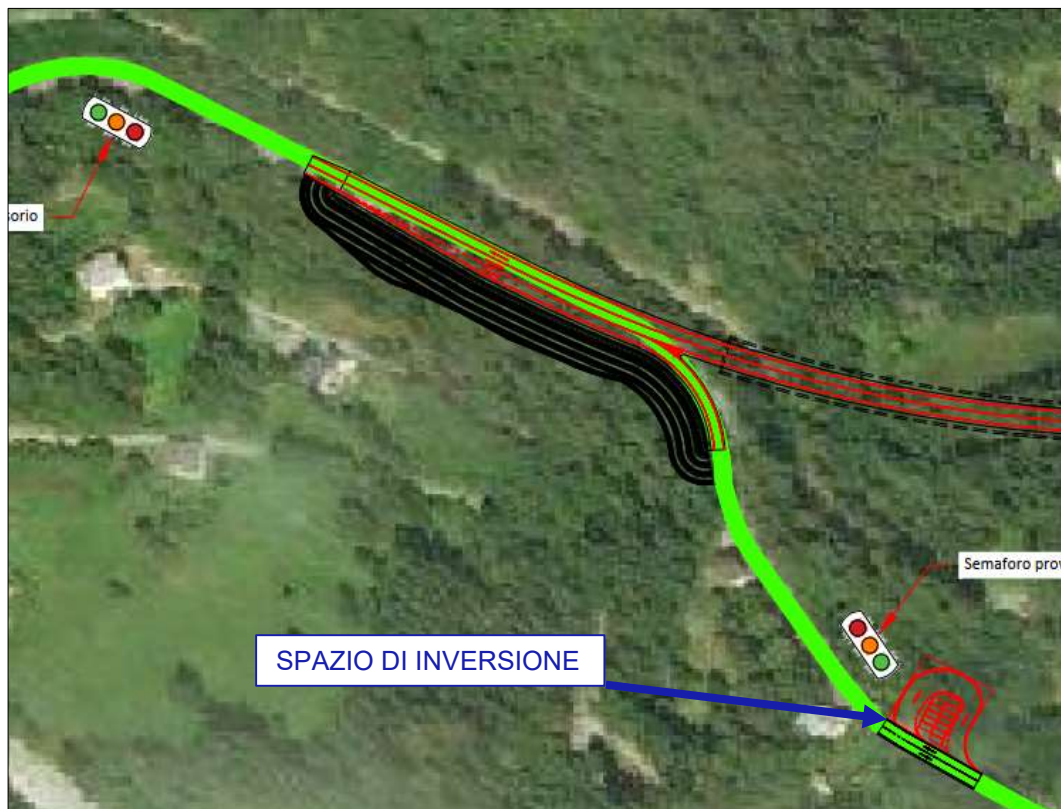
Pianta Svincolo Ovest – fase di cantiere
